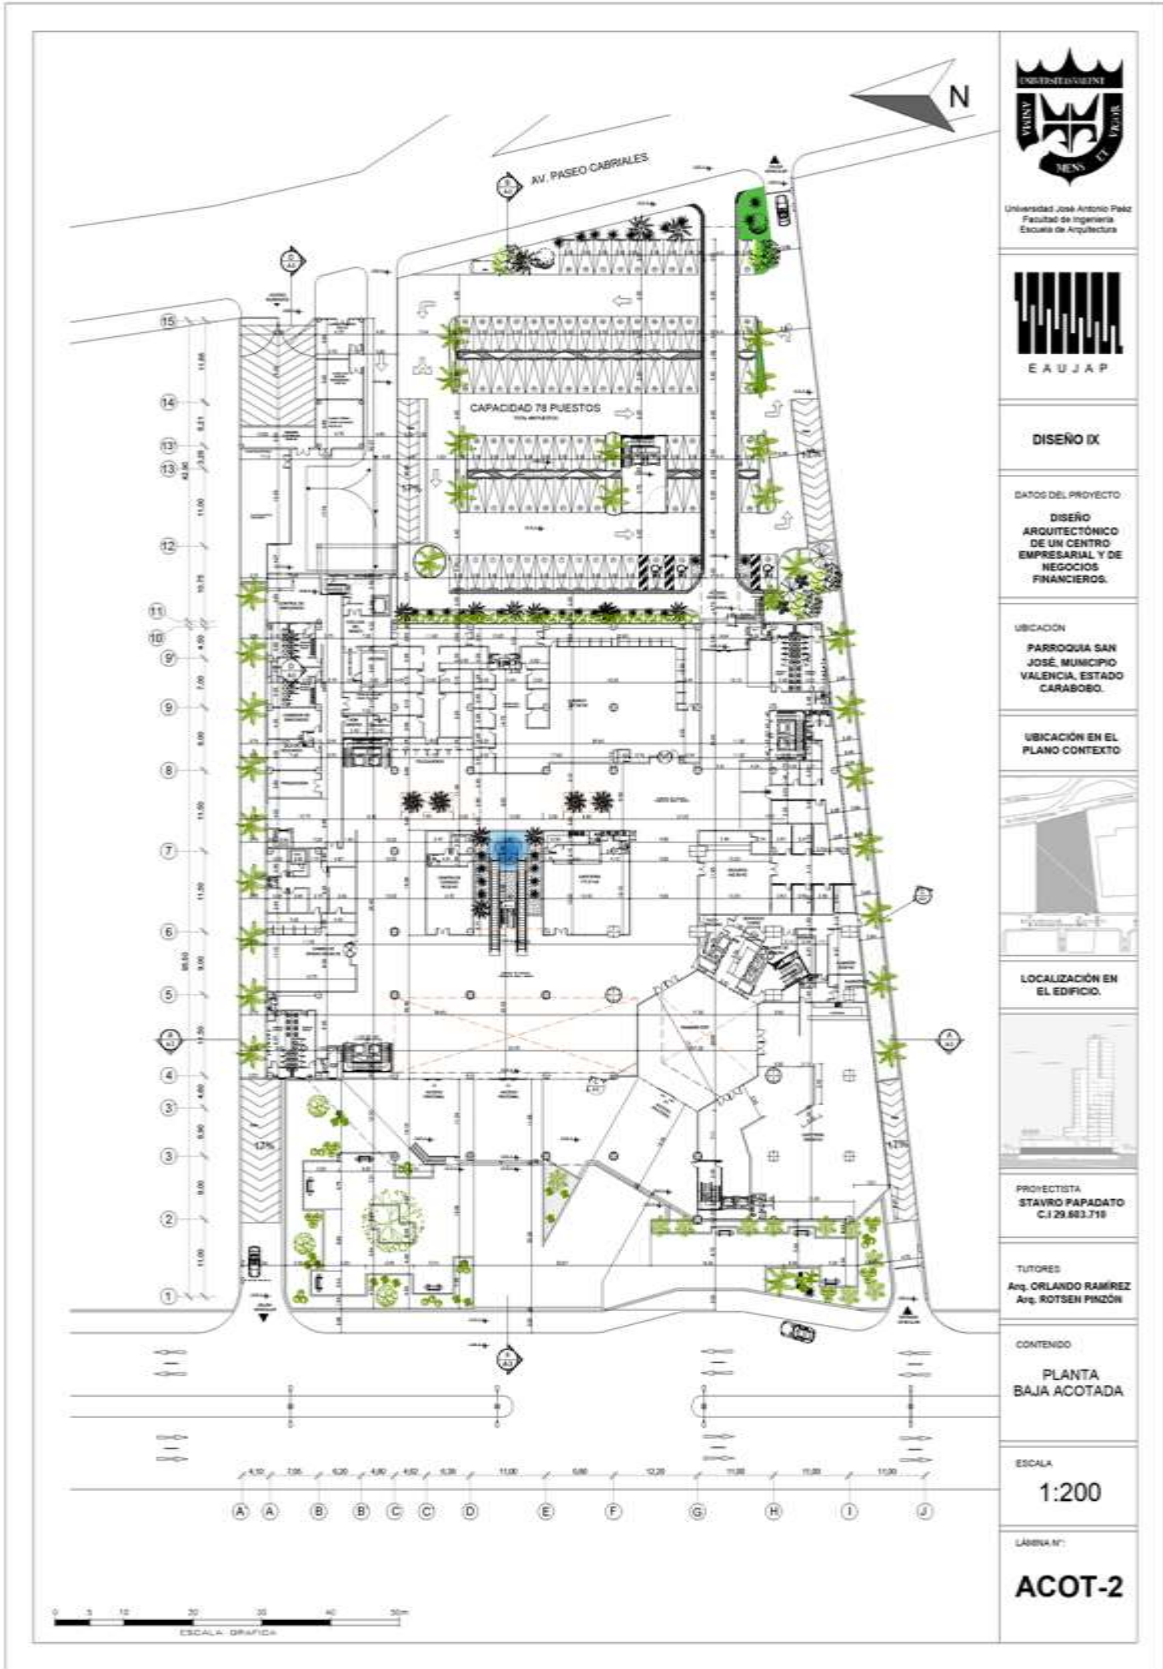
ACOT – 2 Planta Baja Acotada Fuente: El Autor (2023)
